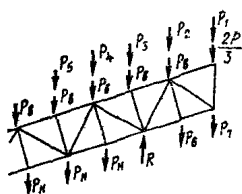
Схема приложения нагрузок на консольном участке фермы
